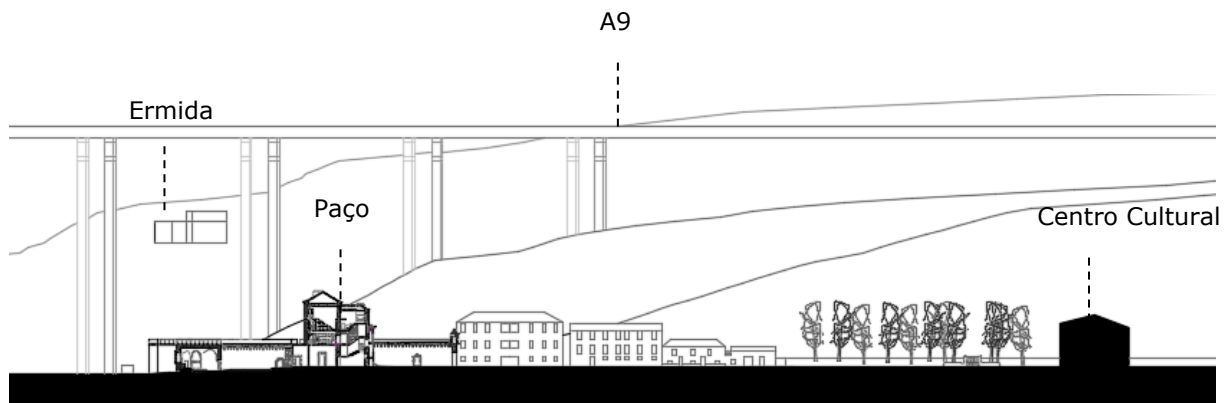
Corte transversal do Paço e da praça 5 de outubro. Autoria própria
